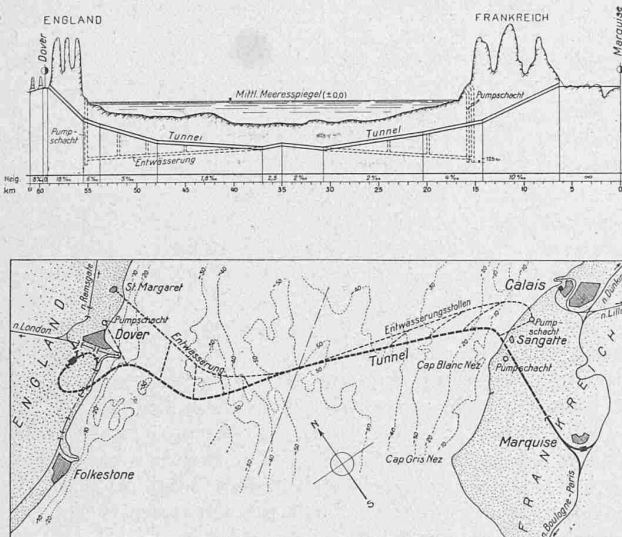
und 2. Lageplan und Längenprofil des Kanaltunnels.
